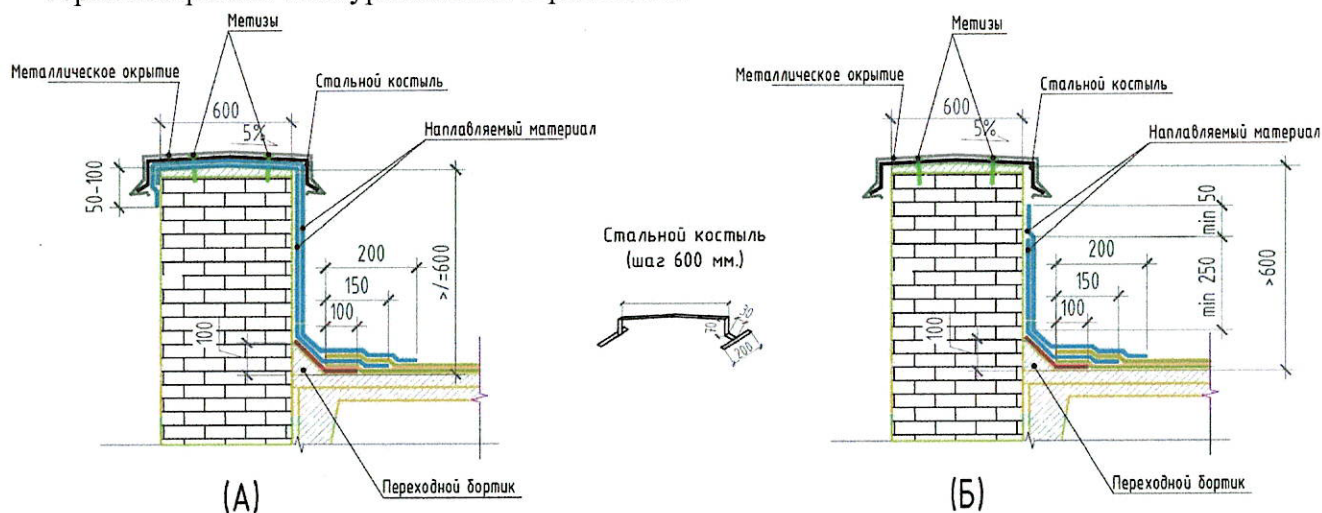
Устройство примыкания и покрытия парапета: а – высотой не более 600мм; б – высотой более 600мм
